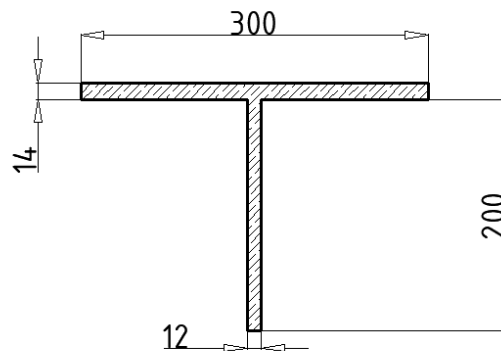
Поперечний переріз повздовжнього ребра верхнього поясу з ділянкою листу настилу.
